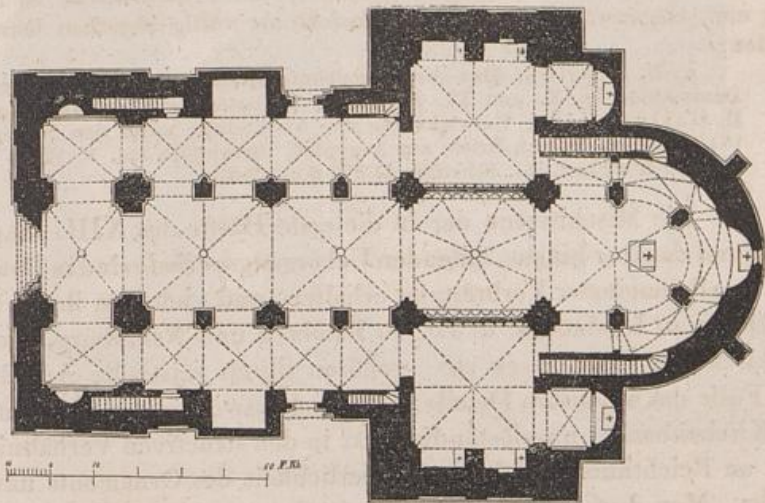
Grundriss des Domes zu Limburg a. d. L. (nach Moller).
